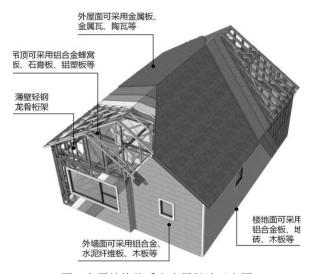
全屋结构体系和房屋做法示意图 3.2.2墙体结构系统和复合墙体构造做法示意图
